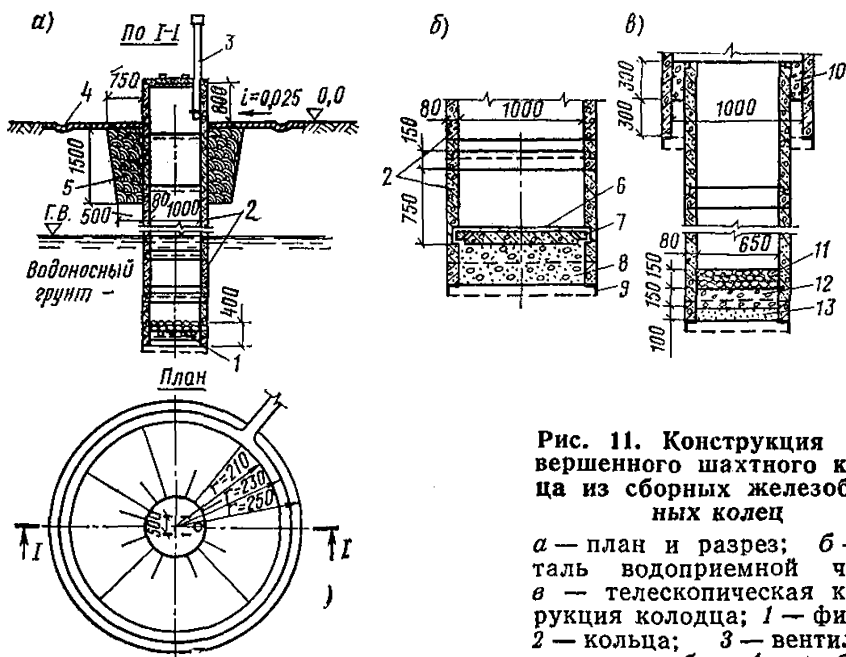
Конструкция несовершенного шахтного колодца из сборных железобетонных колец
